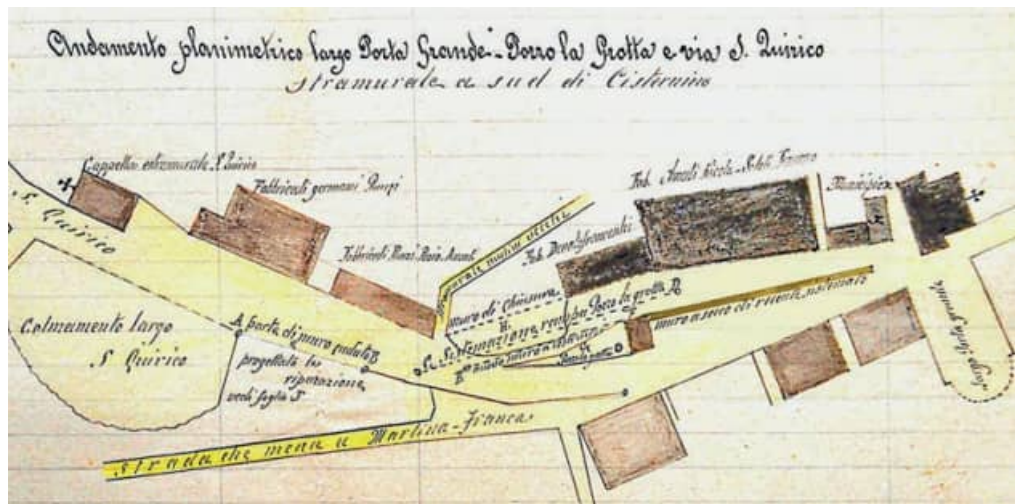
Da questa planimetria si vede la posizione della cappella delle anime del Purgatorio indicata con la lettera E
